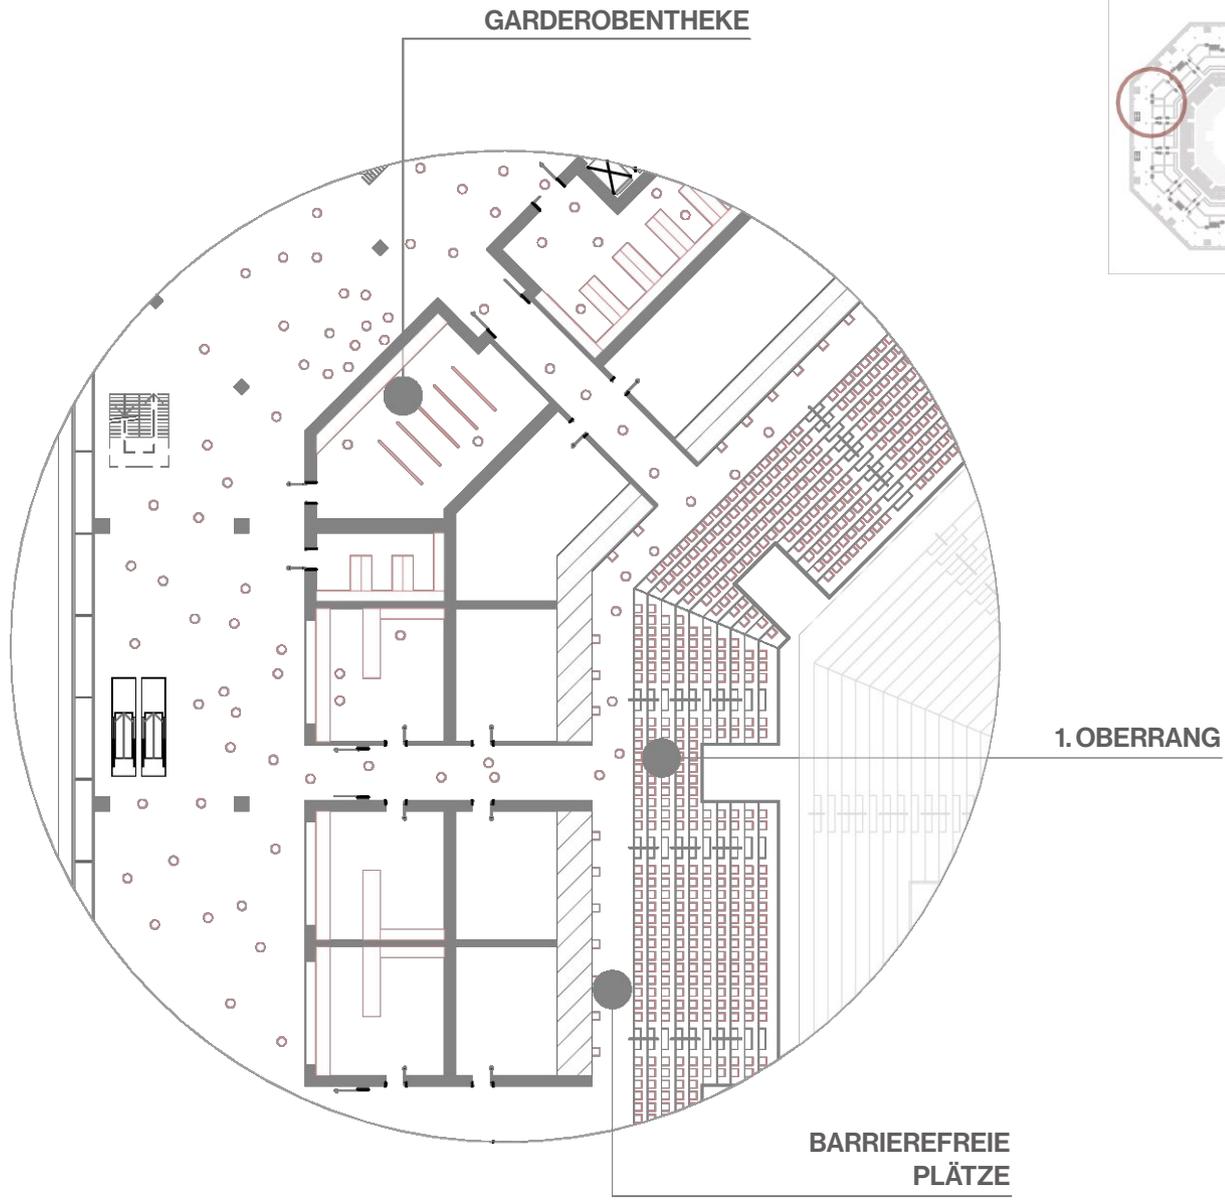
Grundriss 2. OG Zoom 1
